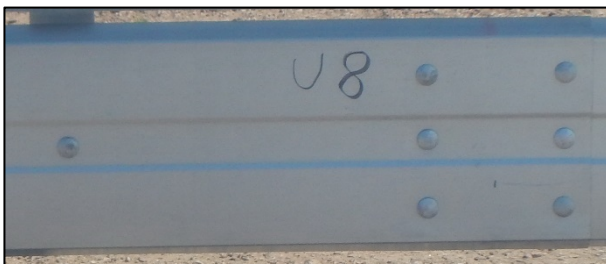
Verschraubung des UFS an Bügel und Stoß (Frontseite)
